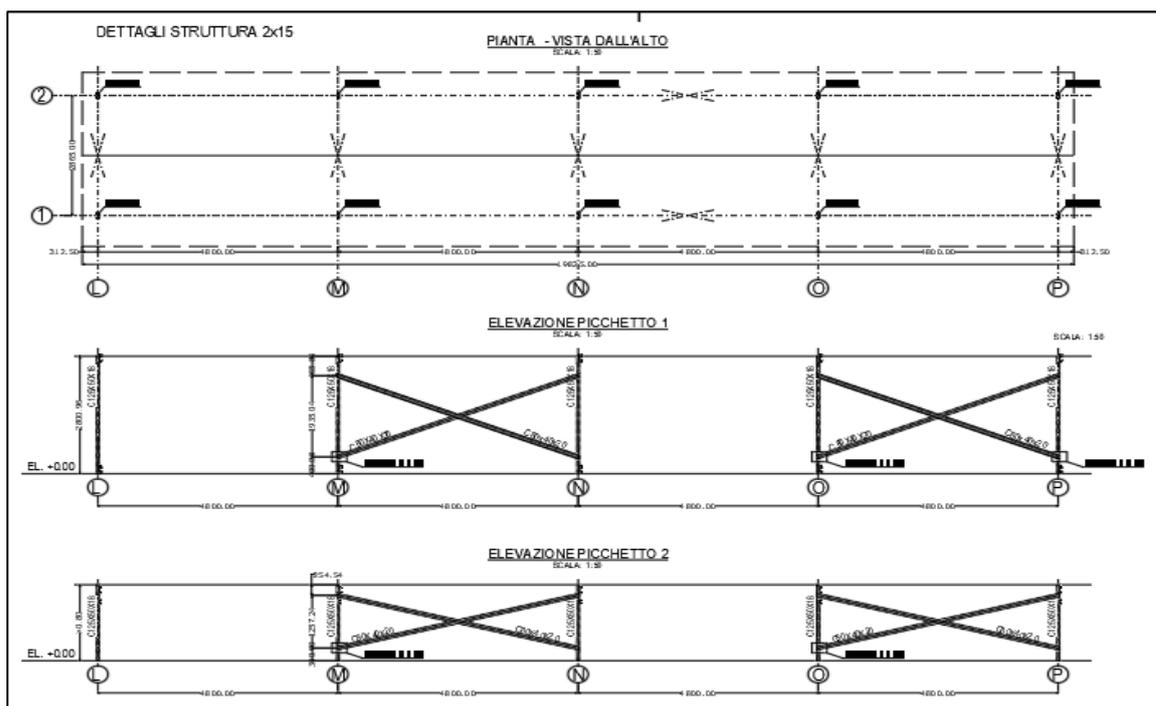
Configurazione Struttura portamoduli 2x15 (viste dall'alto e sezioni longitudinali)
